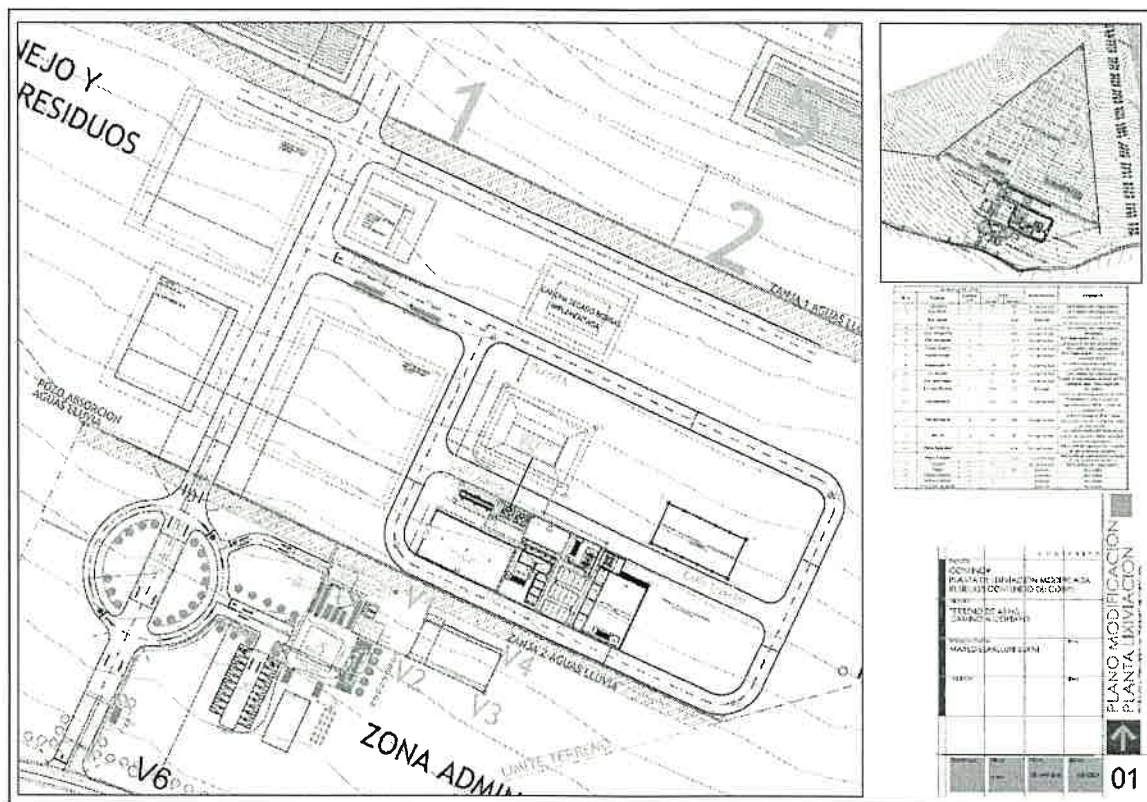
Vista general Planta de Valorización e instalaciones colindantes, situación proyectada.
